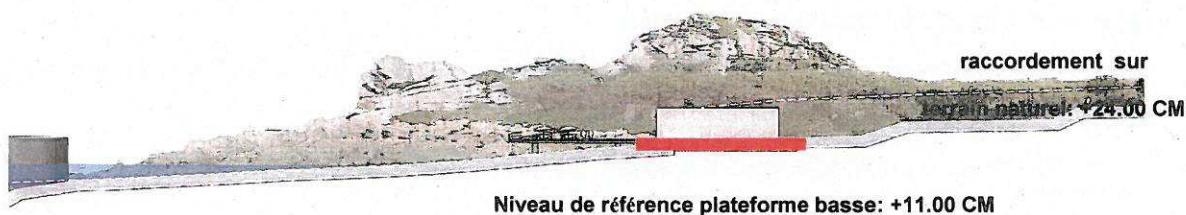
coupe niveau de références (source : schéma directeur J-F.Revert)
